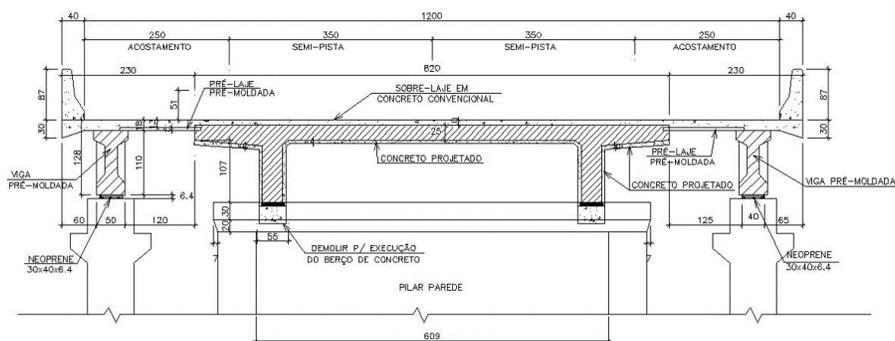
Alargamento de uma ponte com a utilização de vigas e pré-lajes pré-moldadas
